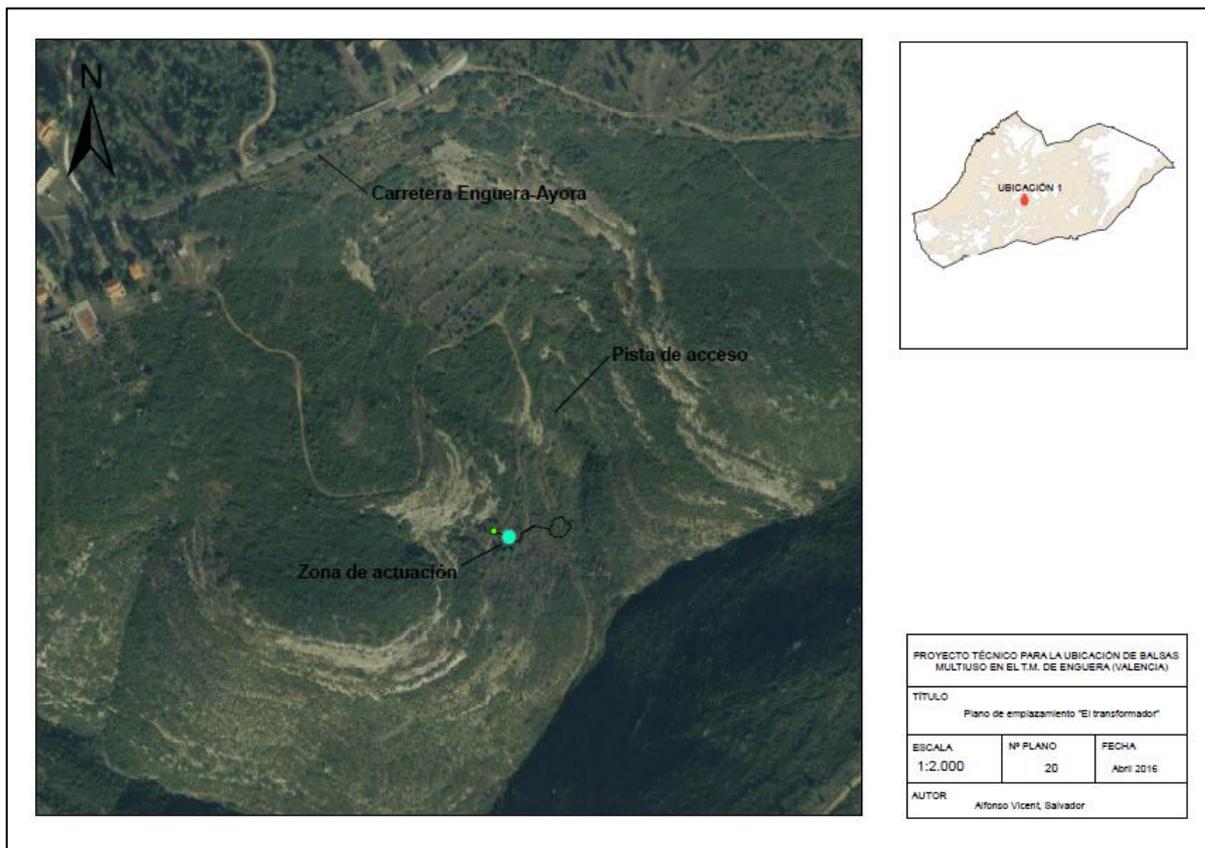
Plano de emplazamiento "El Transformador". Fuente: elaboración propia con Autocad
